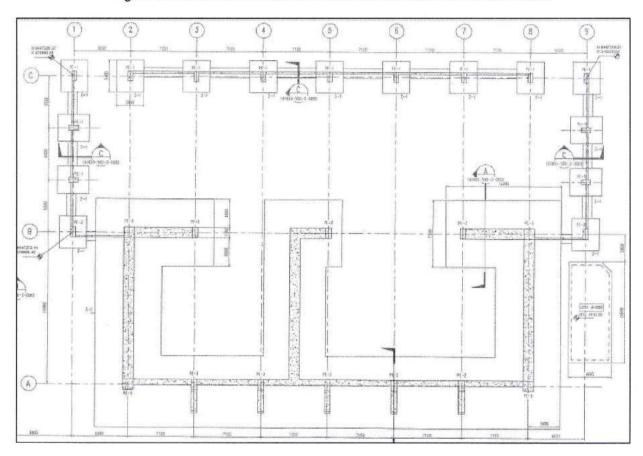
Planta de cimentación de edificio de filtrado de concentrados
